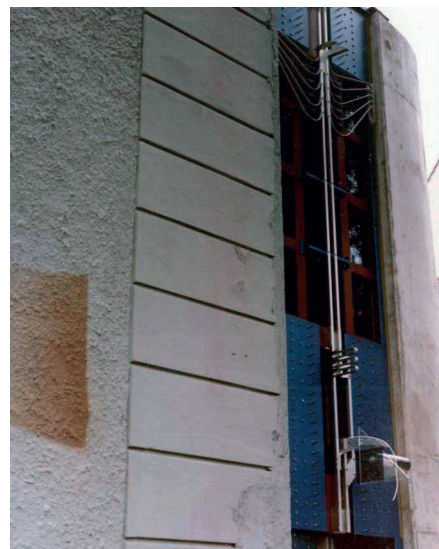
Eingangssituation mit abgerundetem Treppenhaus
